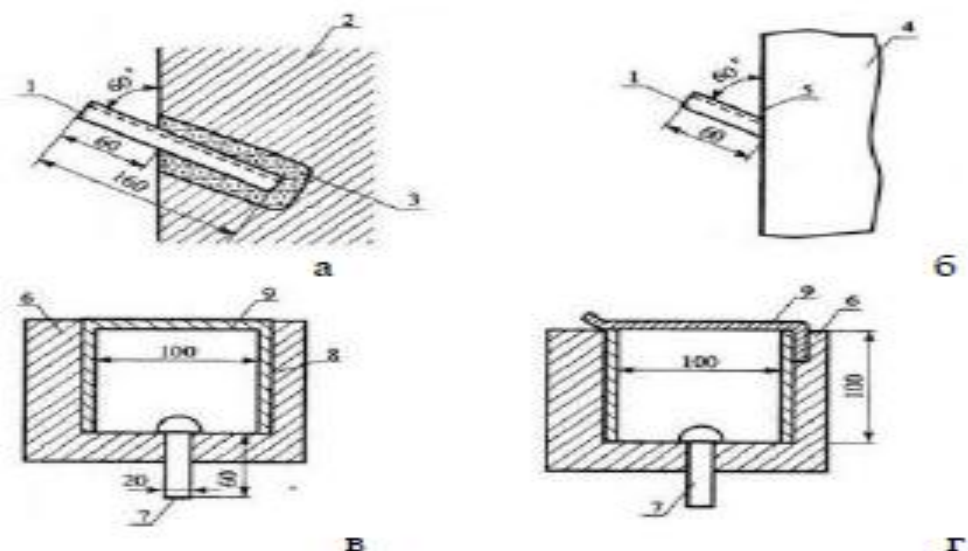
Нивелирные марки стенные (а и б) и в фундаментных плитах (виг: а- в каменных стенах; б- на стальных колоннах; в- с ввинчивающейся крышкой; г- с откидной крышкой);
